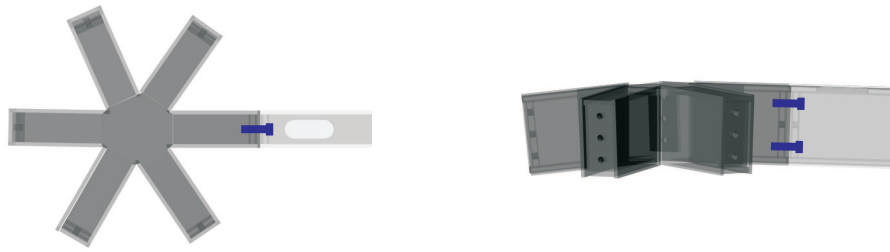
Endstückknoten mit längsgerichteten Schrauben
